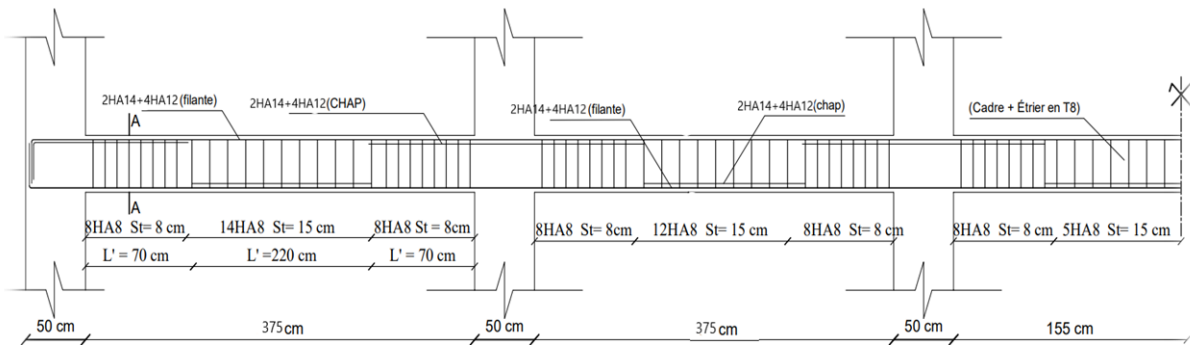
Schéma de ferrailage des poutres principales en travées
